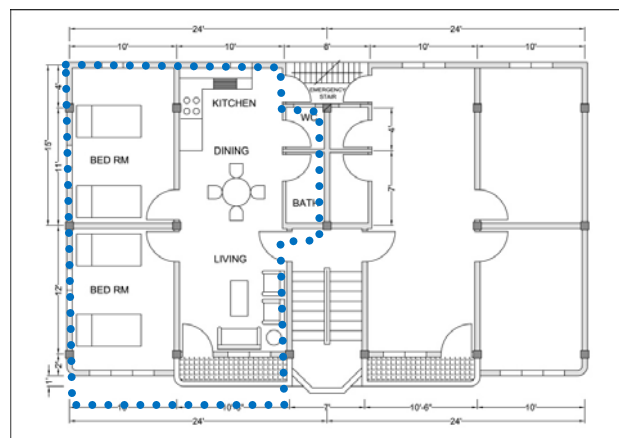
計画平面図 (クラス II, III 賃貸用および分譲用)
